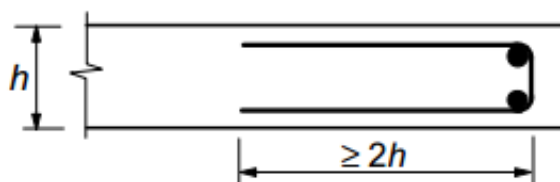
Armaduras de bordo livre numa laje (Figura 9.8 do EC2)
